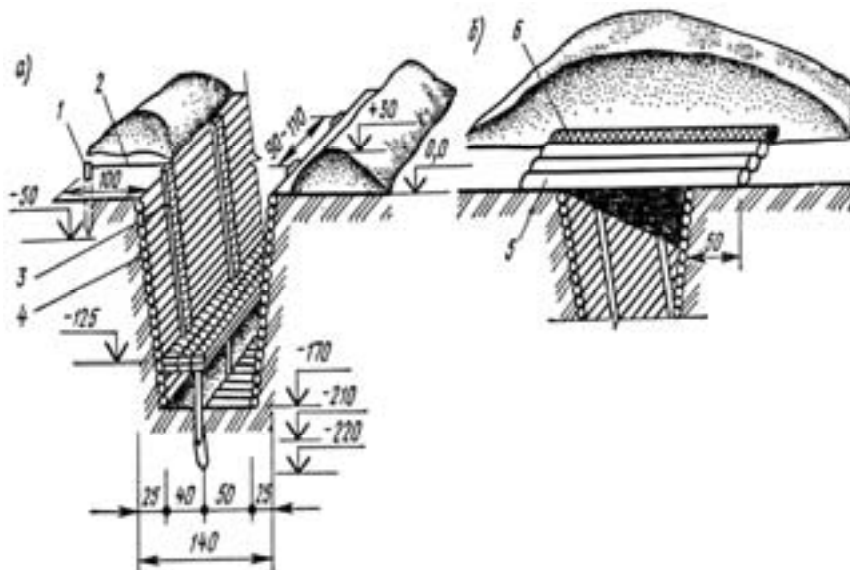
Щілина: а) відкрита; б) з перекриттям із колод; 1 – кілок;
